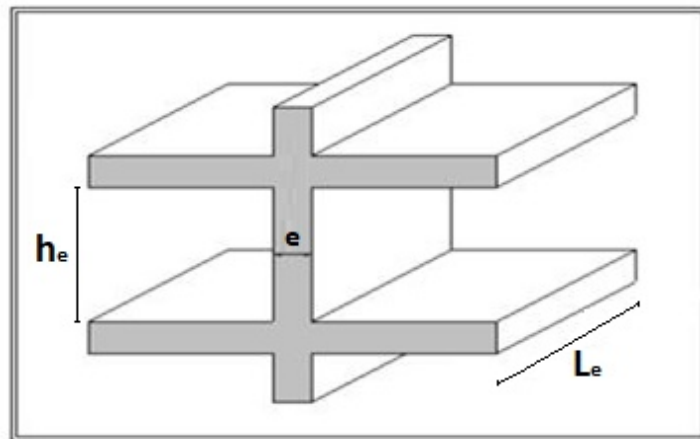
Coupe sur voile en élévation selon le RPA 99 / version 2003
